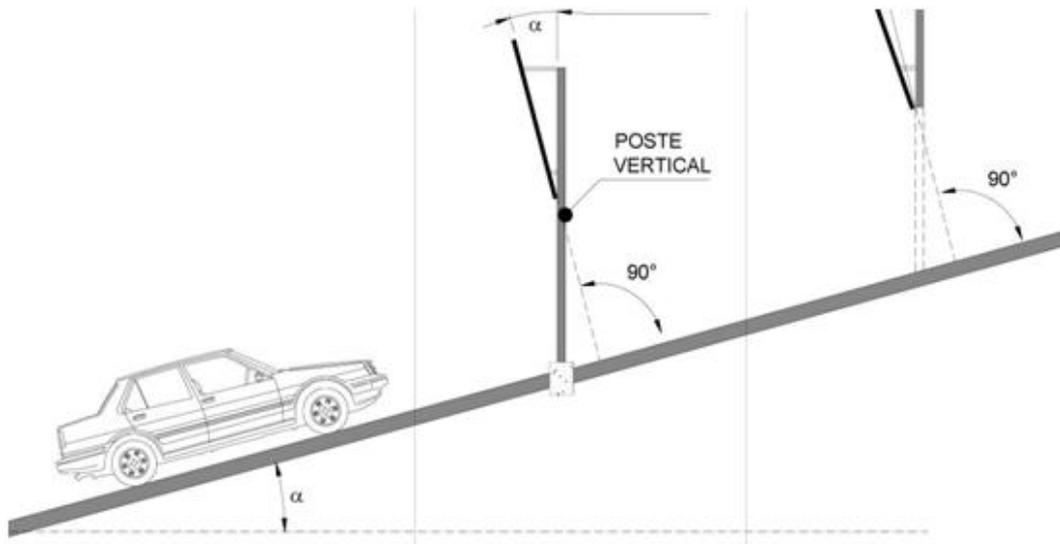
ORIENTACIÓN DE LAS SEÑALES (VISTA EN PLANTA)
